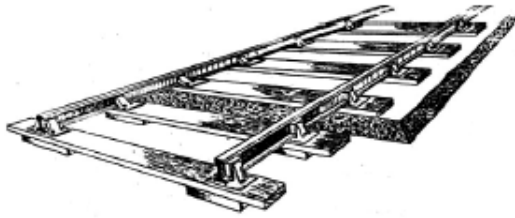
Vía sobre durmientes mixtos de madera y hormigón.
